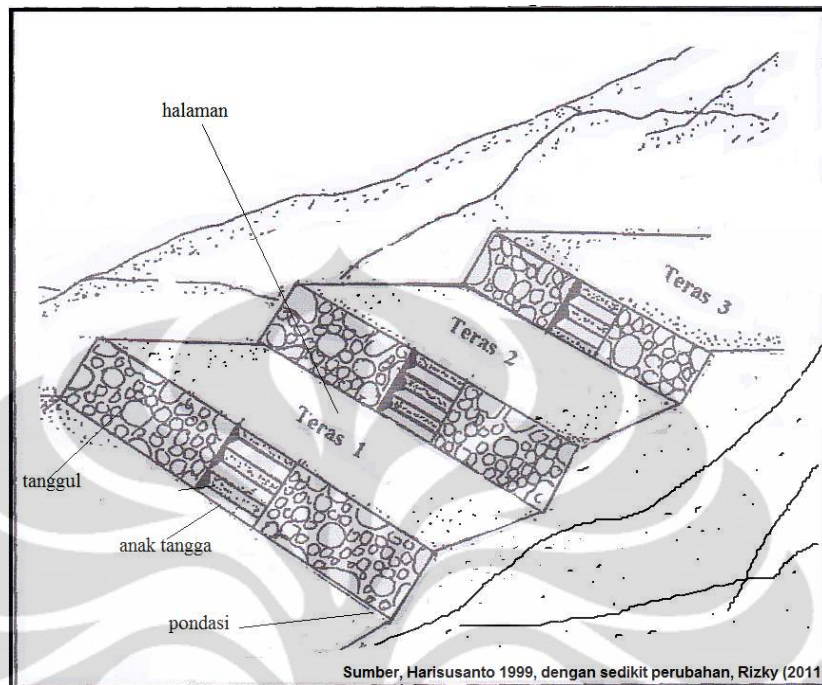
Bangunan Berundak Yang Terasnya Membentuk Selasar Bangunan (tipe p) (Munandar, 1990)
